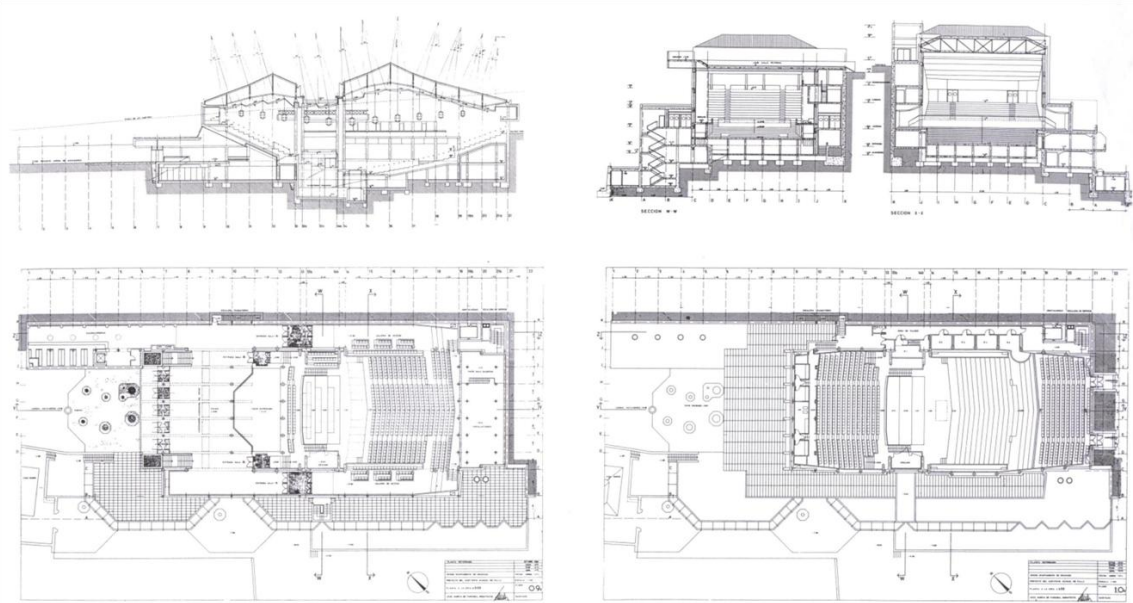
Secciones longitudinal y transversal. Plantas (cota 0,00 abajo izda y 4,59 abajo dcha)
